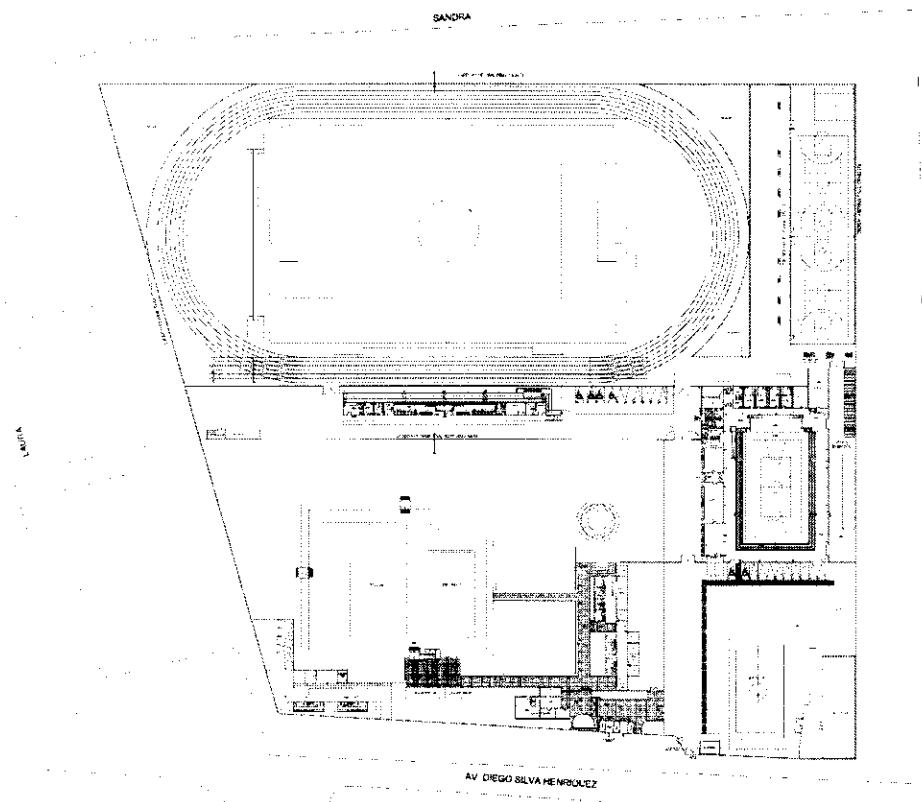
Planimetría Situación Propuesta – Balneario Municipal.
